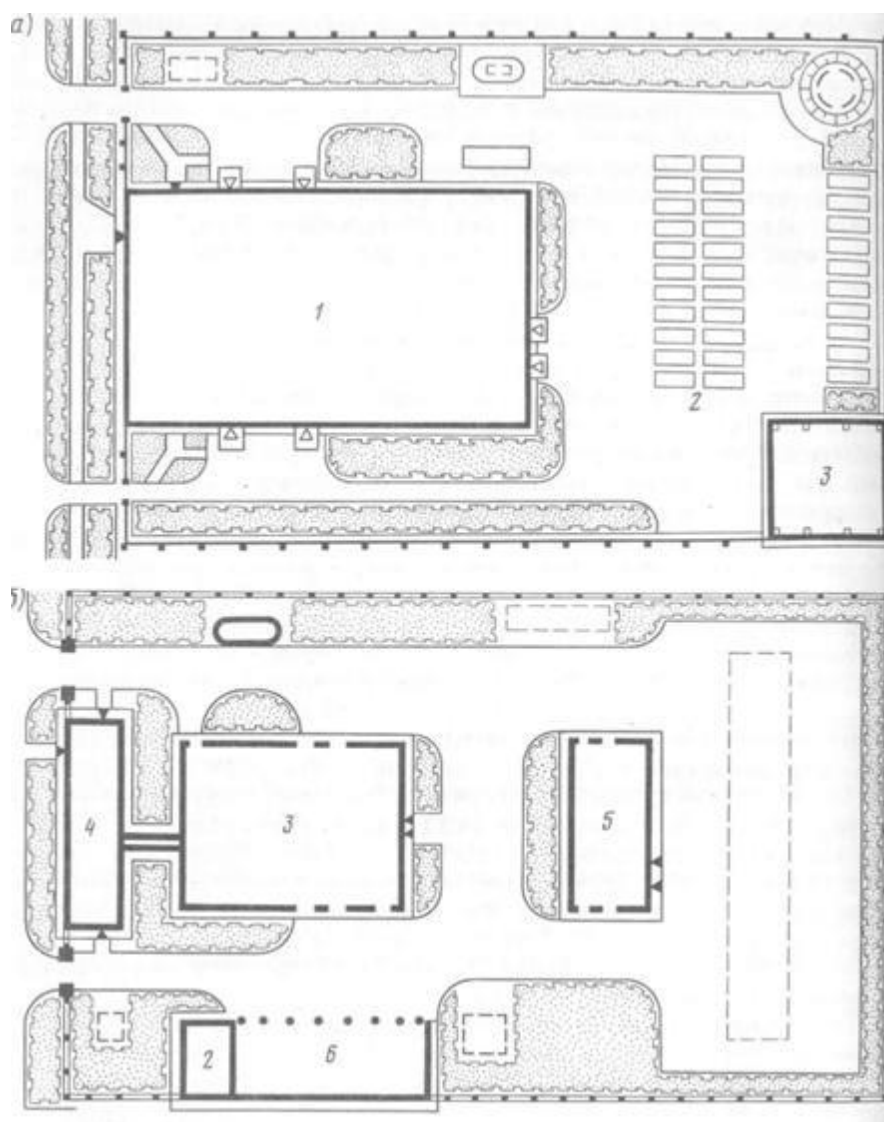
Генеральный план базы на 50 и 100 машин: 1 — открытые стоянки машин; 2 — склад материалов; 3 — главный корпус; 4 — административно-бытовой корпус; 5 — вспомогательный корпус; 6 — навес для хранения сезонных машин
